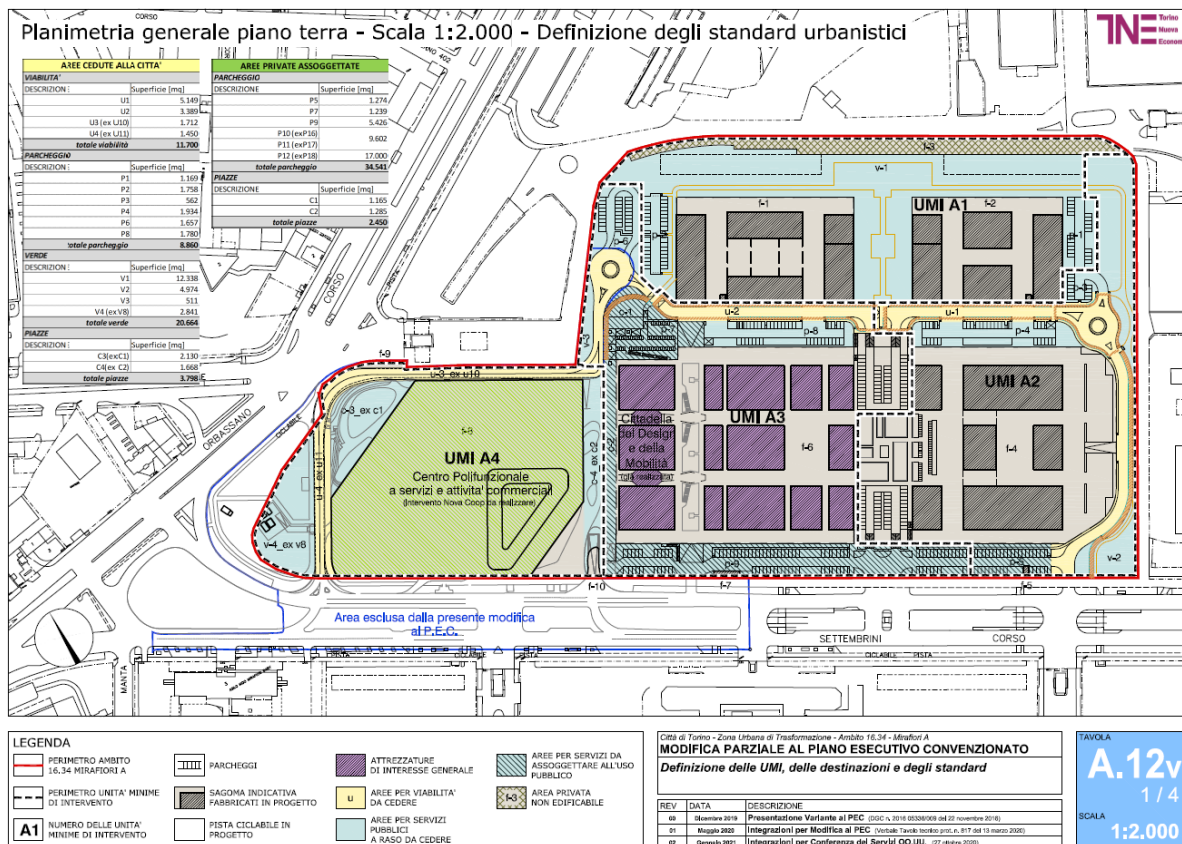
Planimetria di PEC - Definizione UMI, destinazioni d'uso e standard
